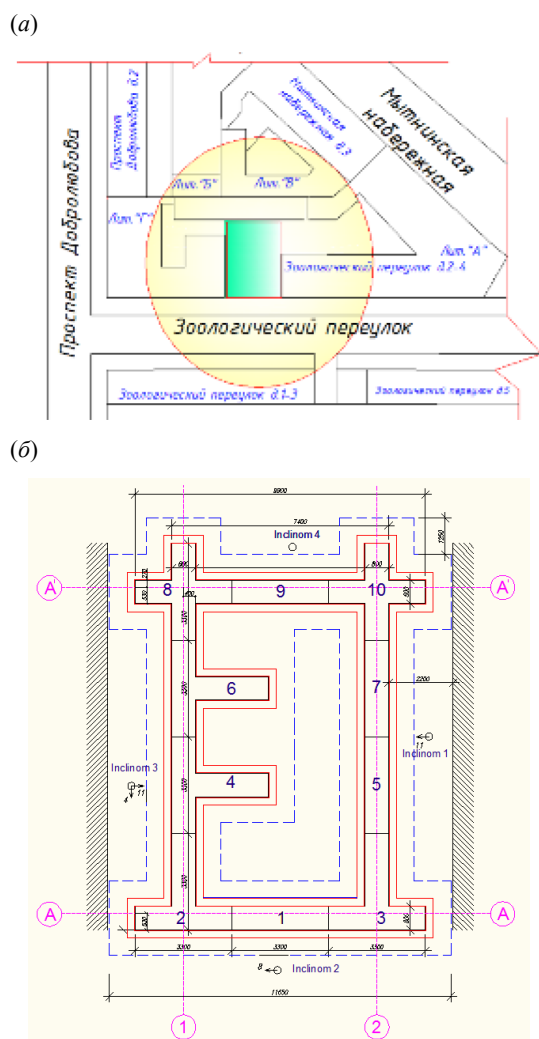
Опытная площадка на Зоологическом пер. в Санкт-Петербурге: (а) – расположение площадки; (б) – схема устройства «стены в грунте» по захваткам
